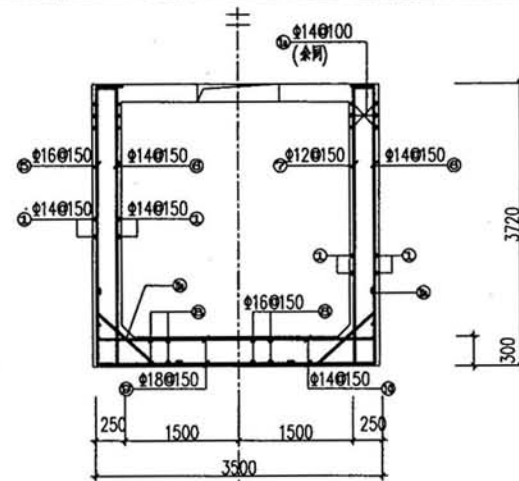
号钢筋混凝土化粪池, 剖面图 (有覆土)			图样号	08J09
